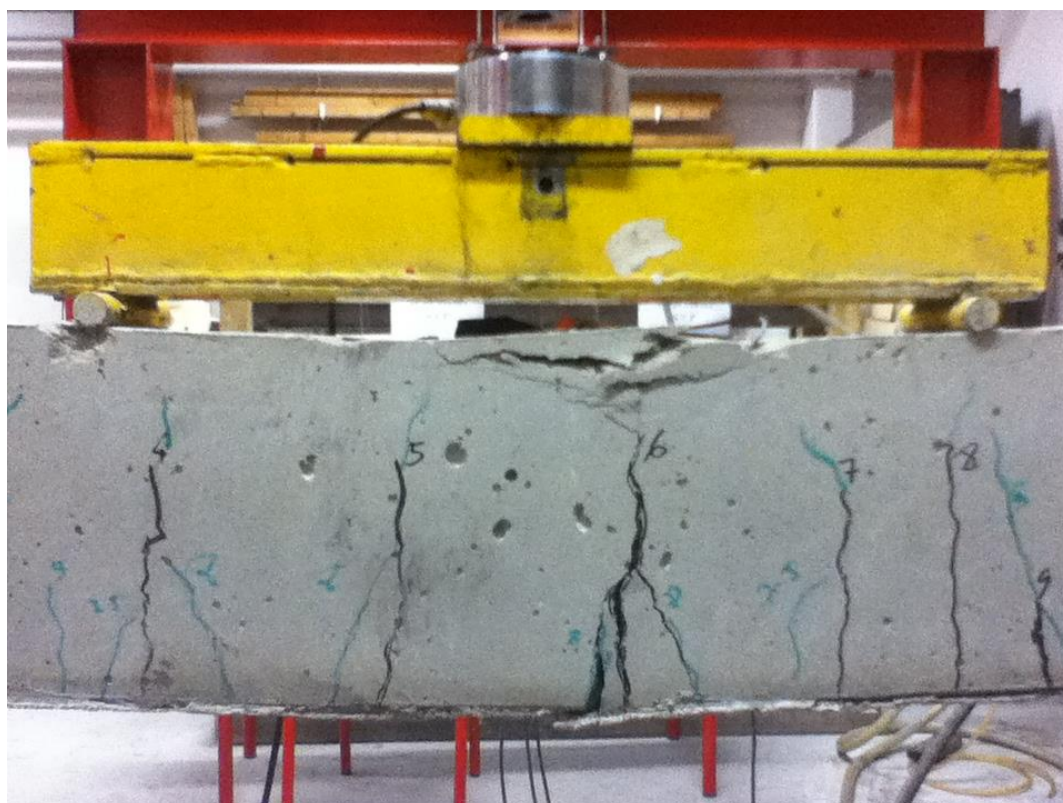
Distribution des fissures de la Poutre renforcée par 1 Couche de TRC + Joncs (P2)
